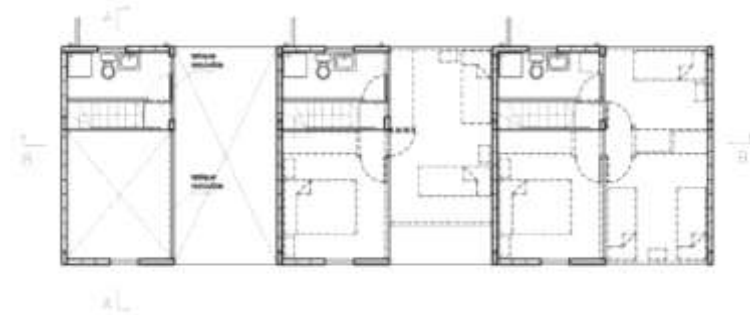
Vivienda tipo dúplex, planta segunda; posibles distribuciones.
